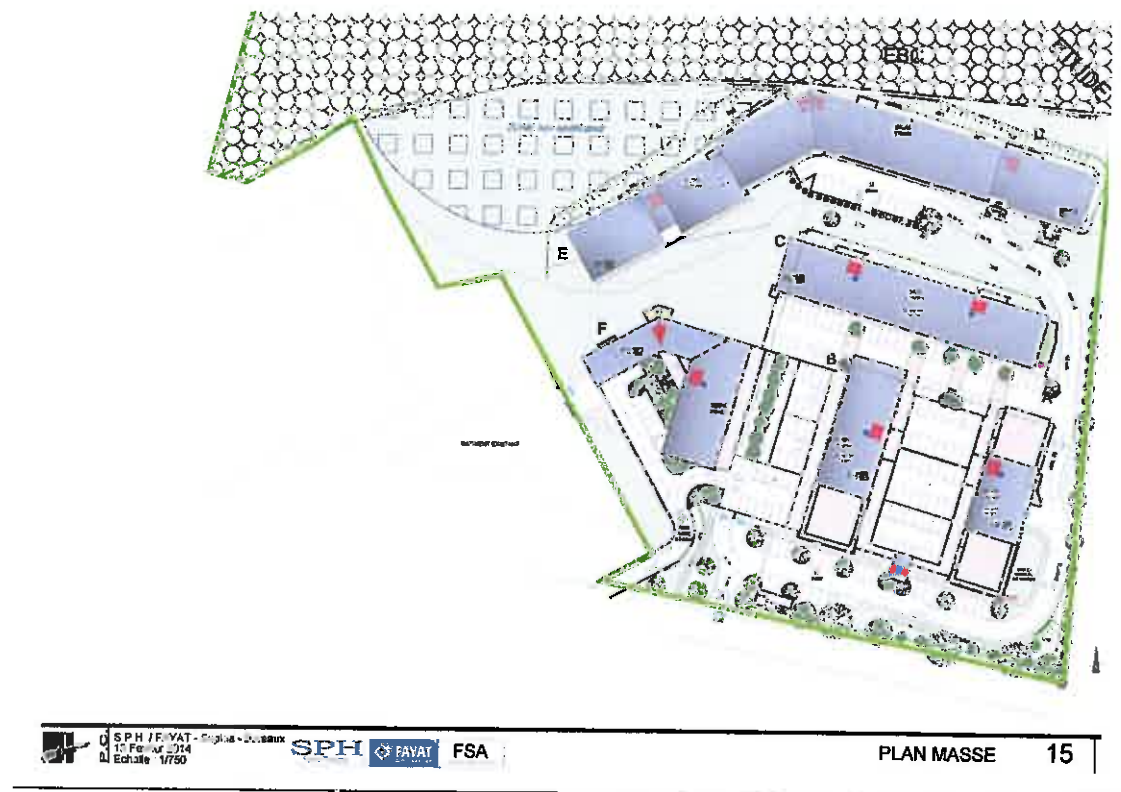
Plan de masse (source : FAYAT Bâtiment)
